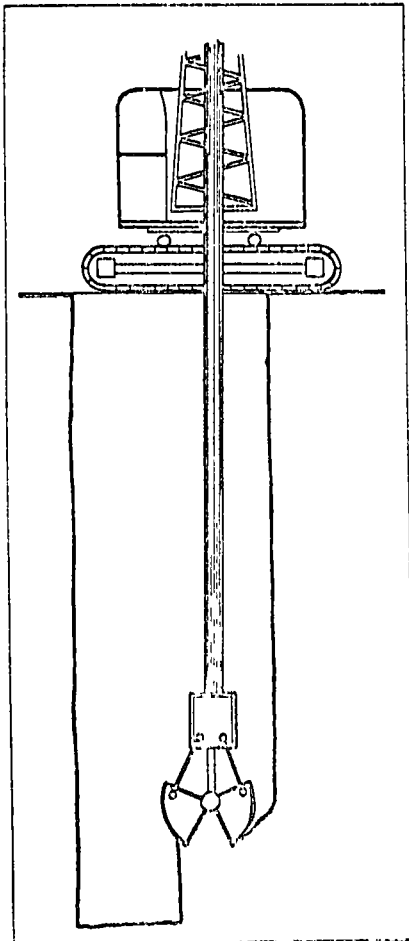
Cuchara de alambre pulida empleada en la excavación de zanjas para muros colados in situ
